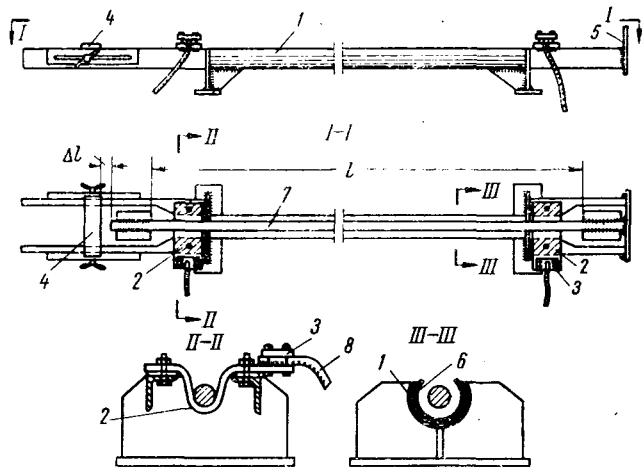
Лоток для электротермического нагрева стержней: 1 — стальной желоб; 2 — медные шины; 3 — зажимы кабеля; 4 — подвижная каретка; 5 — упор; 6 — листовый асбест; 7 — нагреваемый стержень; 8 — кабель от трансформатора
